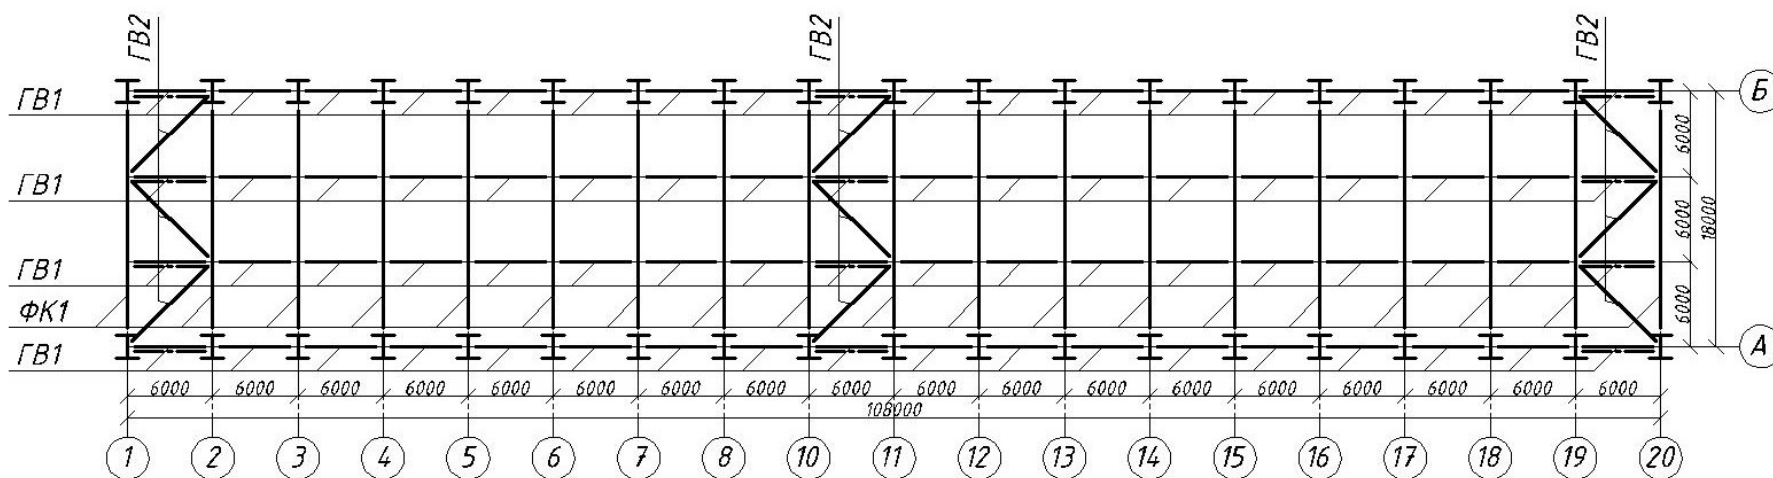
План в'язей по верхніх поясах кроквяних ферм
